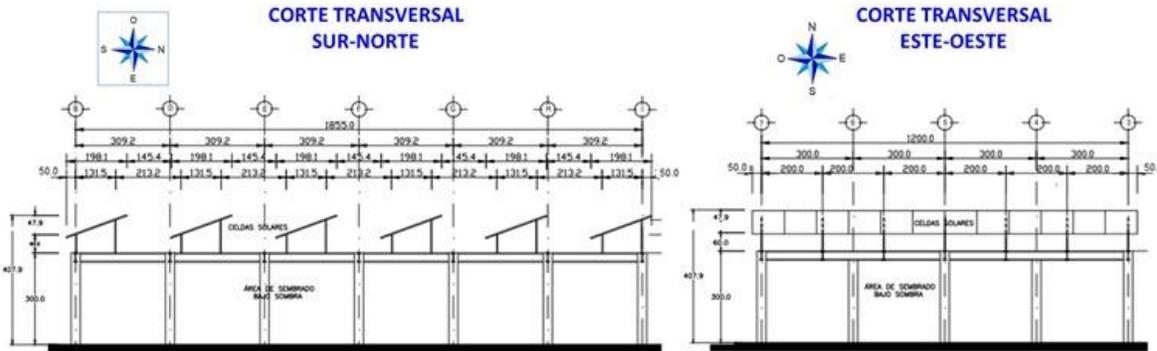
Vistas en corte transversal del sembrado de los MFV's instalados sobre la EMR.
